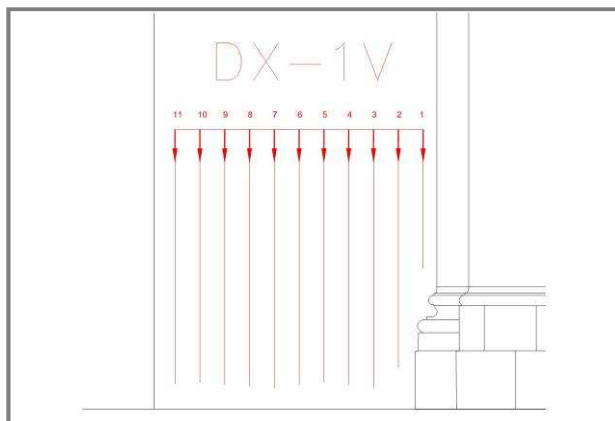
Posizione dei profili verticali alla destra dell'ingresso con distanza di 20cm l'uno dall'altro.
